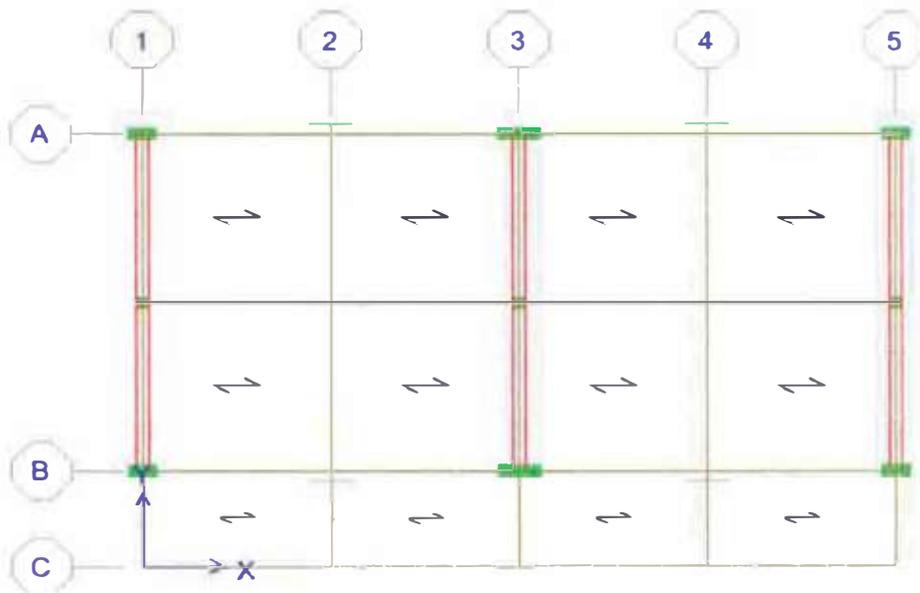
Planta del 1º Piso mostrando sus elementos.
